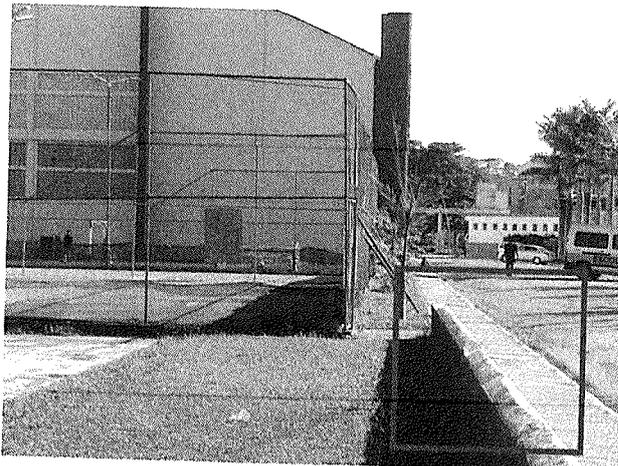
Mureta e muro de fechamento existente na Praça de Esportes
